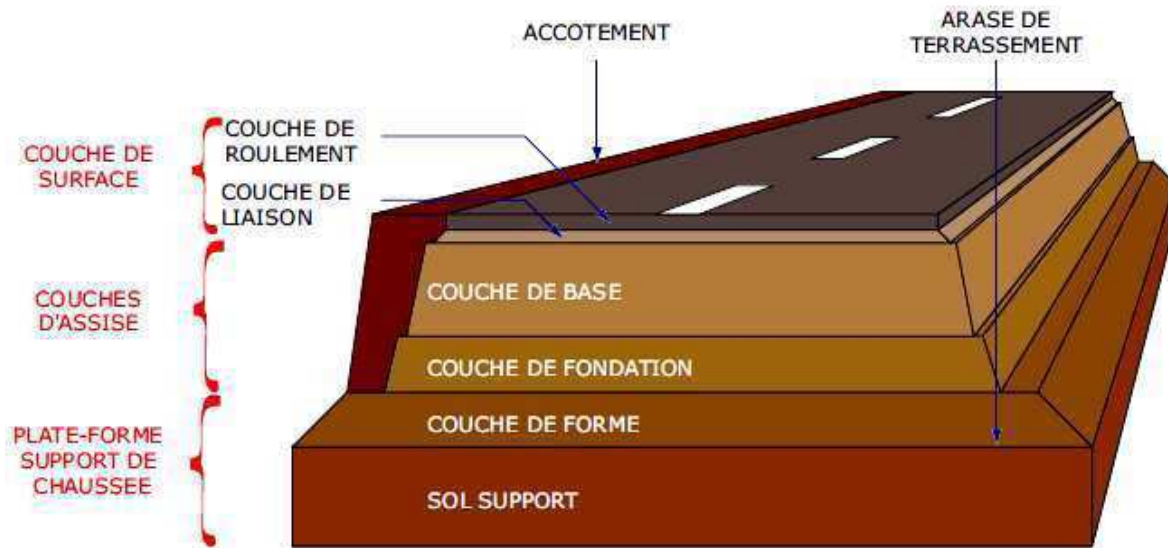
Coupe type d'une structure de chaussée et terminologie des différentes couches
